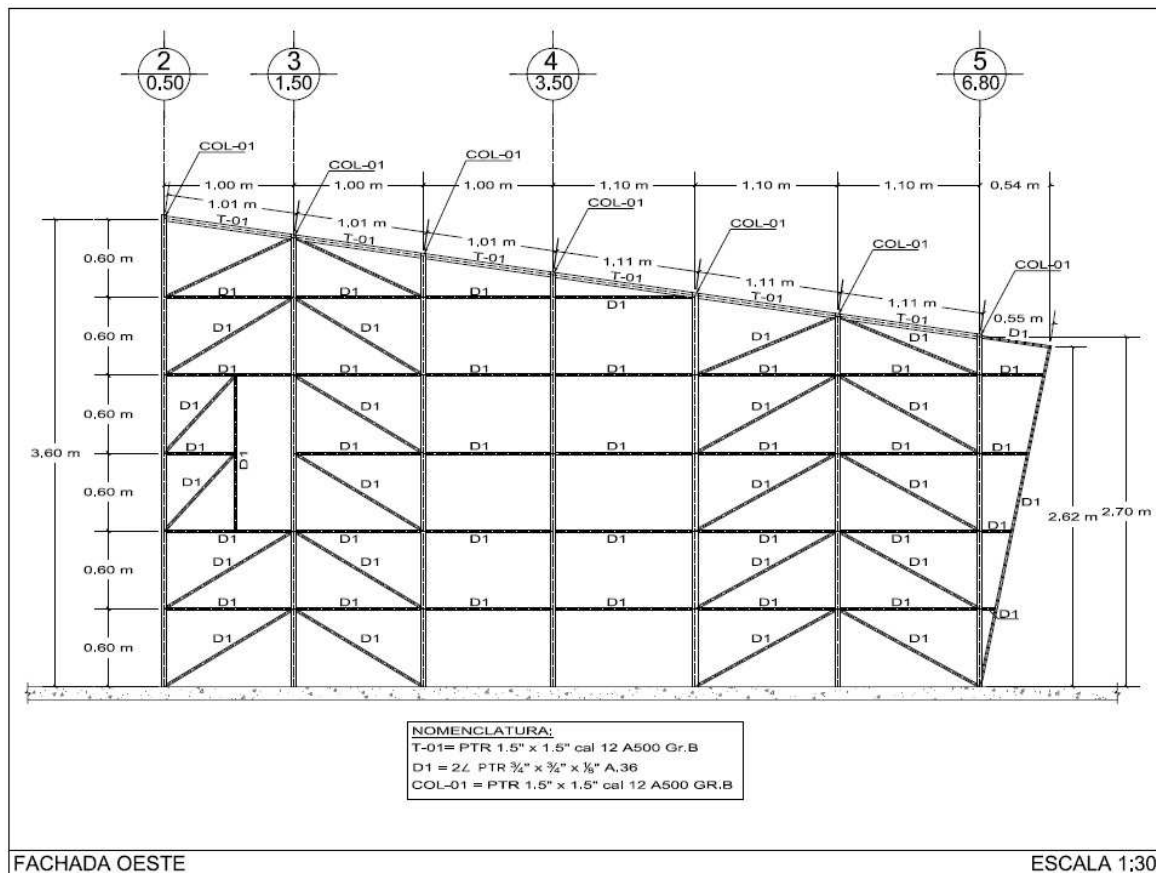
Fachada Oeste de plano estructural de propuesta a base de panel simple.
